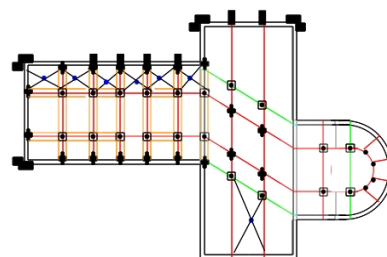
la projection des voûtes sur le plan (croix bleues) découpe l'espace en sous-éléments.
